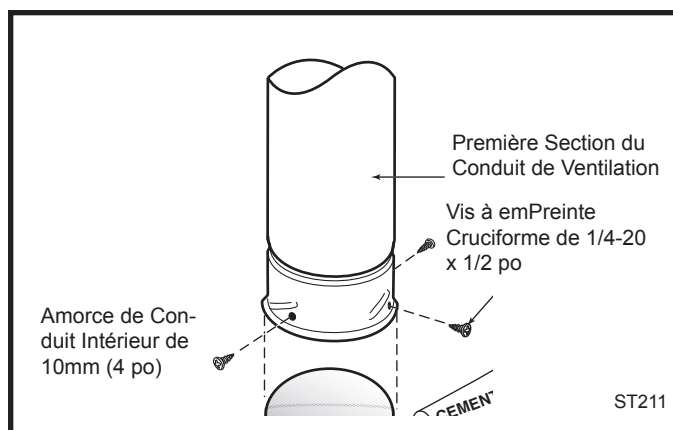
Raccordez l'amorce de conduit à la section suivante du conduit de ventilation intérieur.
